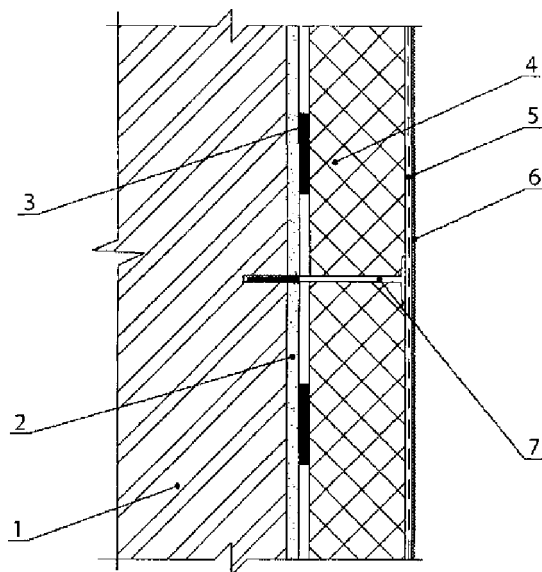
Основний вузол конструкцій фасадної теплоізоляції для даних стін: 1 – несуча частина стіни; 2 – опорядження; 3 – клейовий шар; 4 – шар теплової ізоляції; 5 – захисний шар 6 – опоряджувальне покриття; 7 – елемент механічного закріплення утеплювача.
